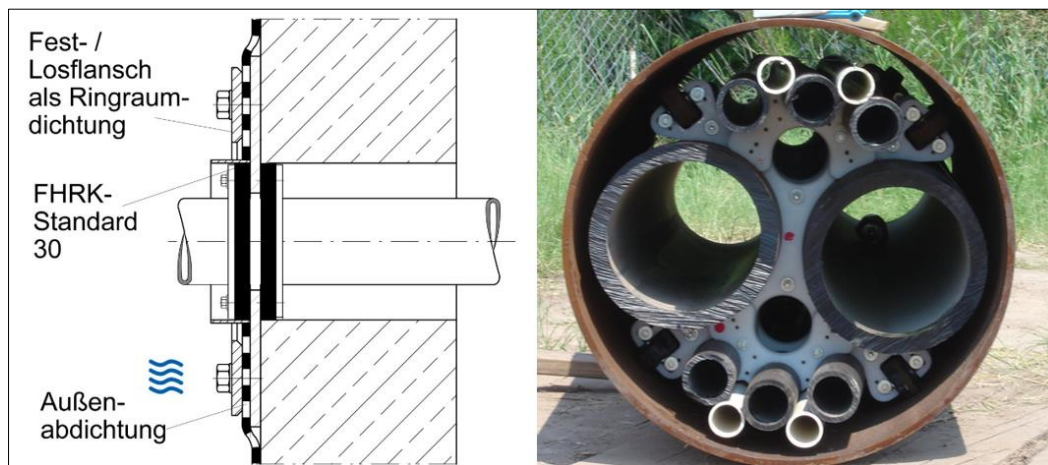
Links: Ringraumdichtung in einer Betonwand (Fachverband Hauseinführungen für Rohre und Kabel e.V.); Rechts: Gebündelte Leitungsdurchführung (Underground Devices)
